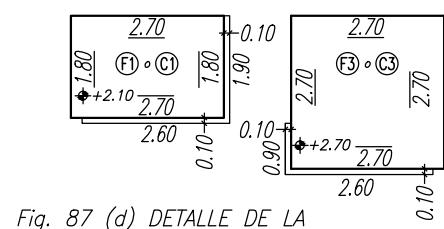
(d) DETALLE DE LA BAULERA Y DEL PLACARD
